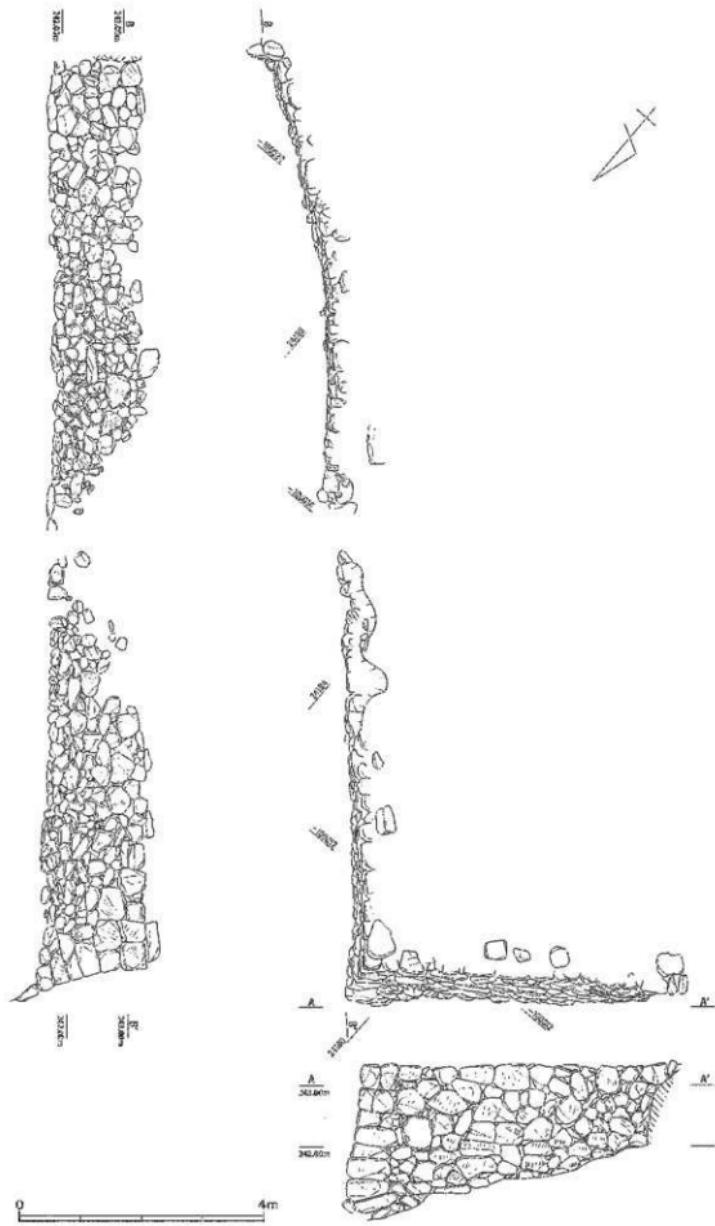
晃布山谷地区第5地点I区SW 02 平面図・立面図 (S = 1 / 80)
